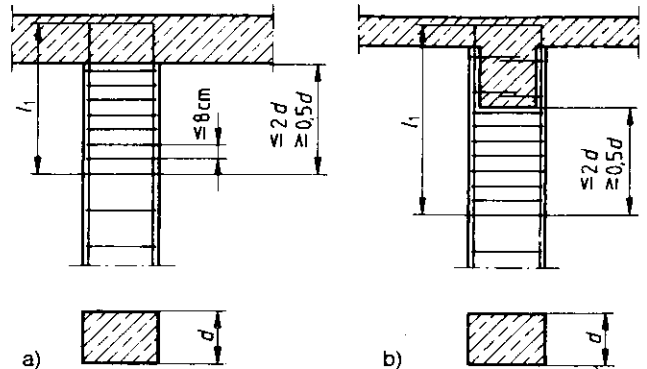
Verstärkung der Bügelbewehrung im Verankerungsbereich der Stützenbewehrung
